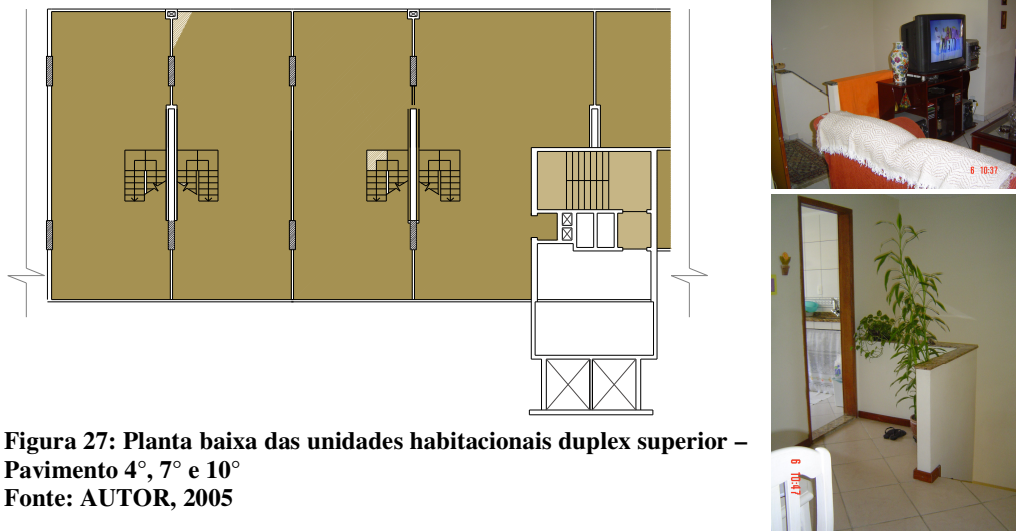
Planta baixa das unidades habitacionais duplex superior – Pavimento 4°, 7° e 10°
